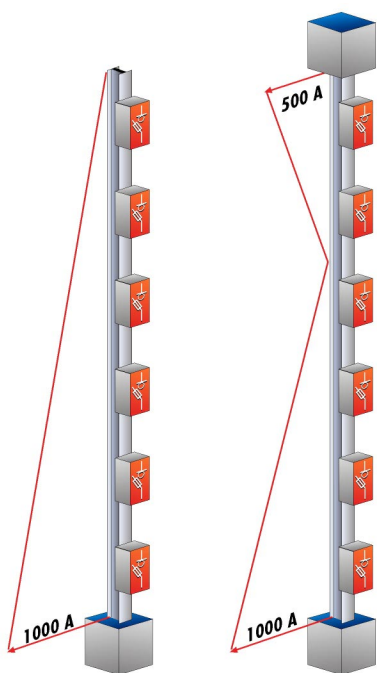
Distribuzione dei carichi nel montante in condotti sbarre nel caso di alimentazione da un estremo o da due estremi.
